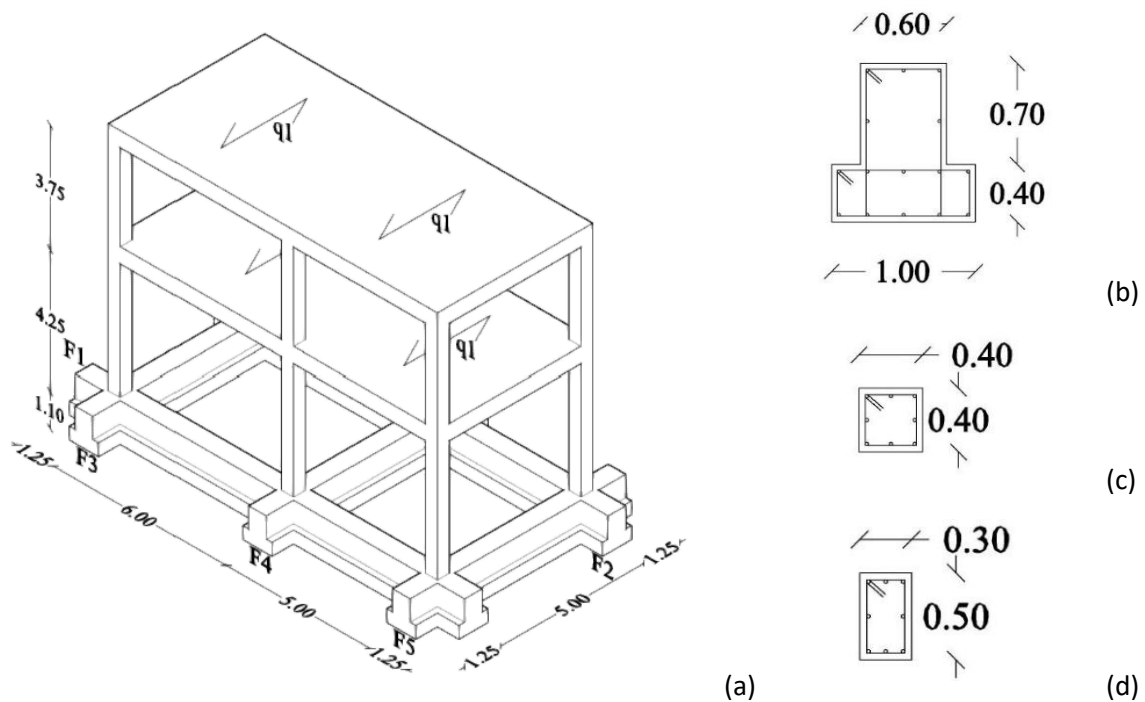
Telaio tridimensionale (in m) e carichi applicati (a); sezione trasversale trave di fondazione (b), colonne (c) e travi in elevazione (d).
